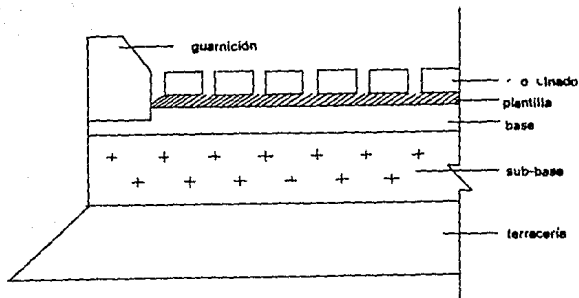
Sección típica de un pavimento de adoquín de concreto para tránsito pesado o industrial.
